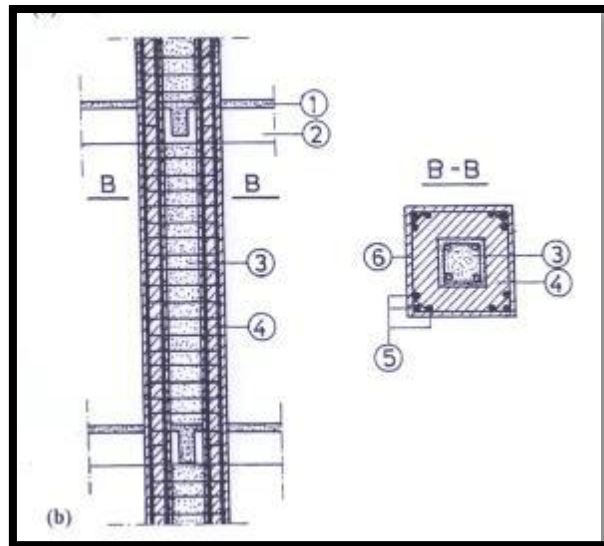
Chemisage d'un poteau en Beton arme [16]
